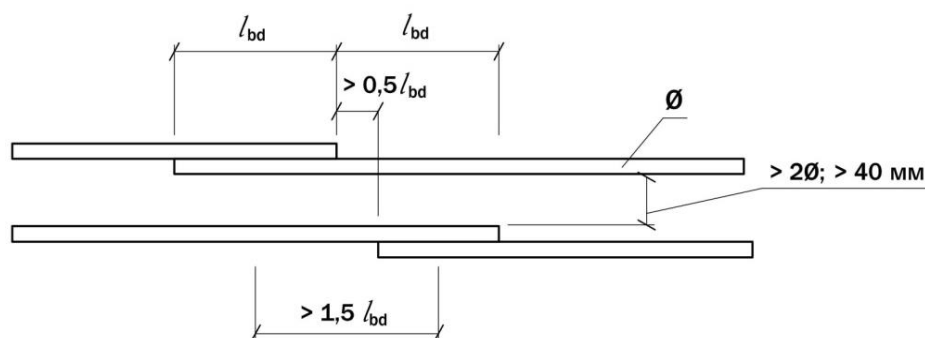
Смещение стержней арматуры при соединении без сварки
